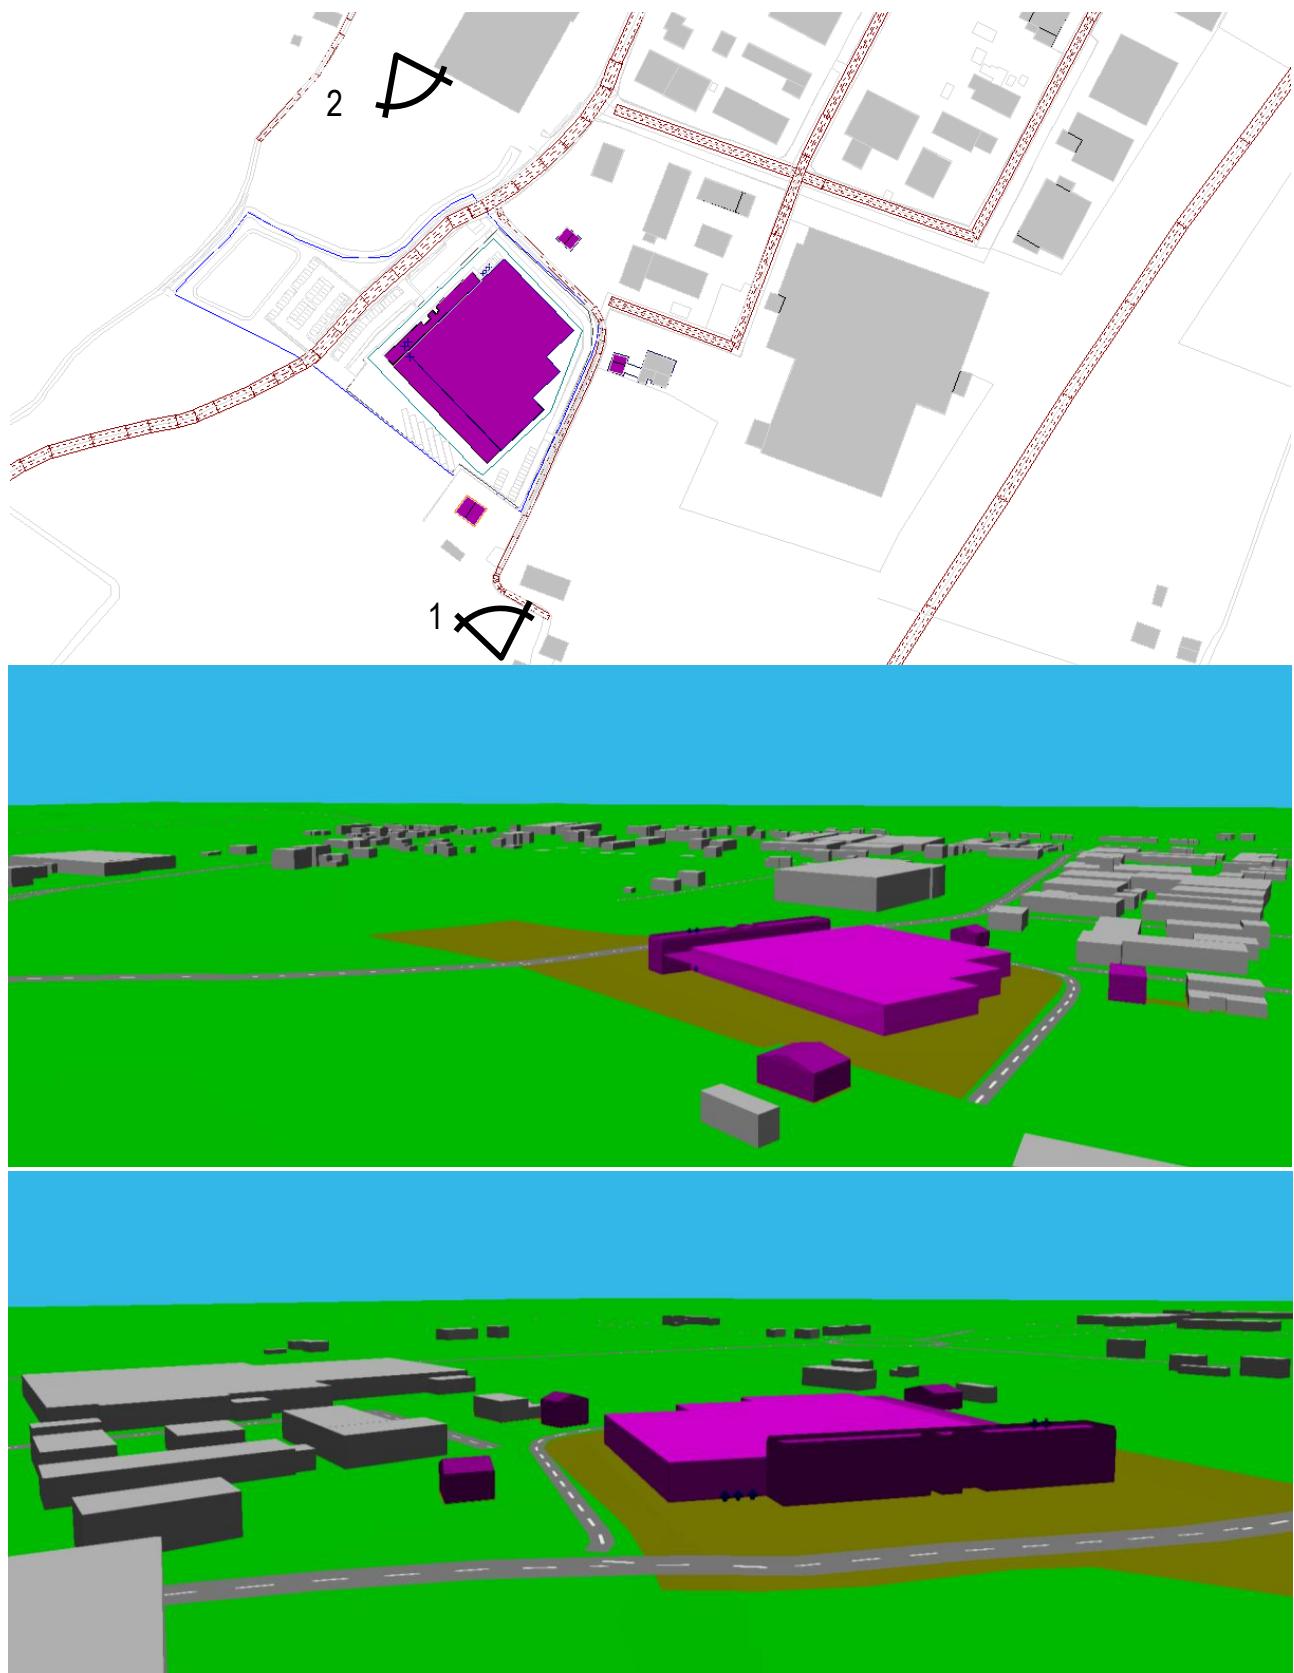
Rappresentazione in pianta e viste 3D (vista 1 sopra e vista 2 sotto) dello stato di progetto con il completamento della nuova Bretella di collegamento.
